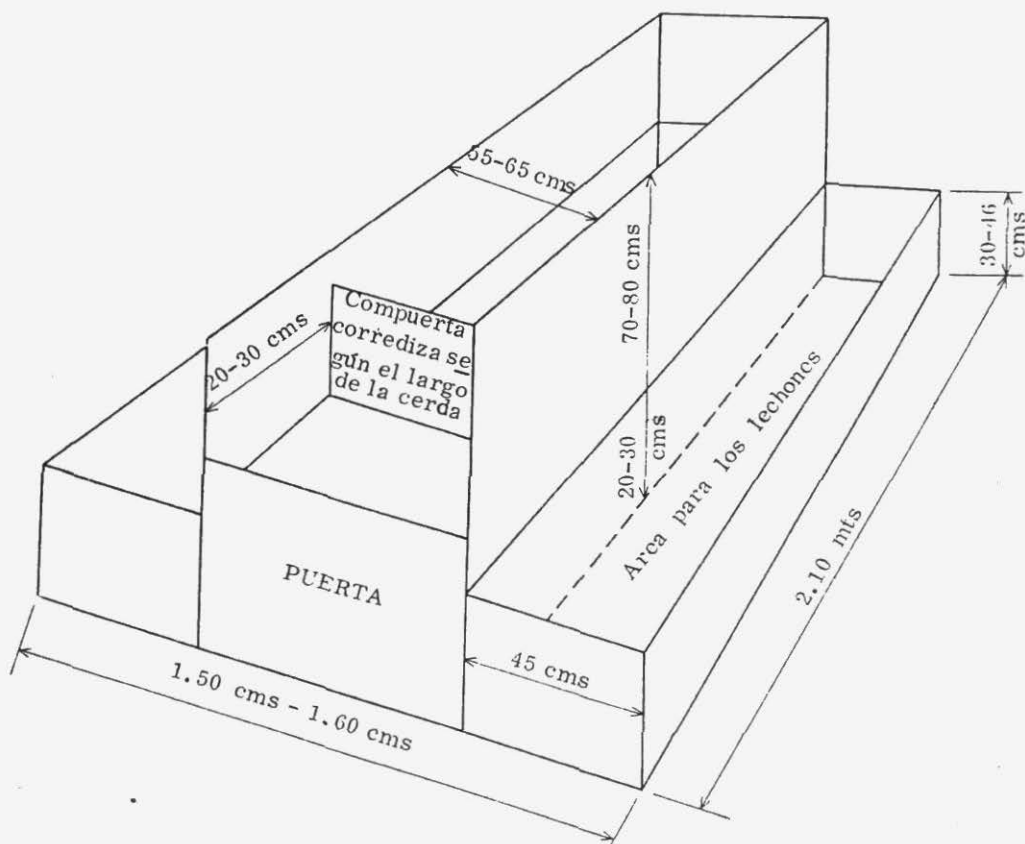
JAULA PARA CRIA CONSTRUIDA DE GUADUA Y MADERA
